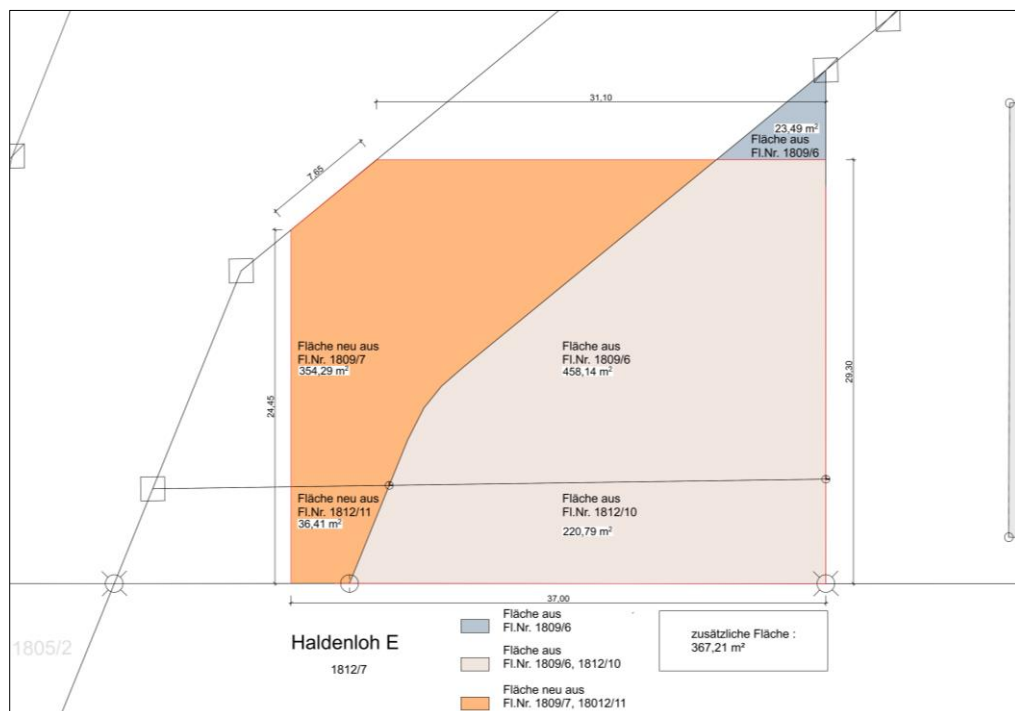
Flächenplan zu geänderter Aufteilung von Bauflächen, © Kögl Architekten, Stand 24.06.2024
